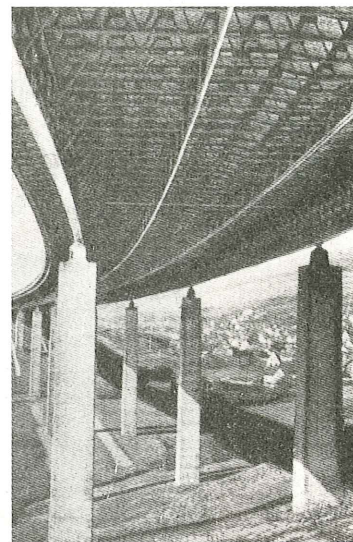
Vista inferior del puente de Kauppen, terminado.
